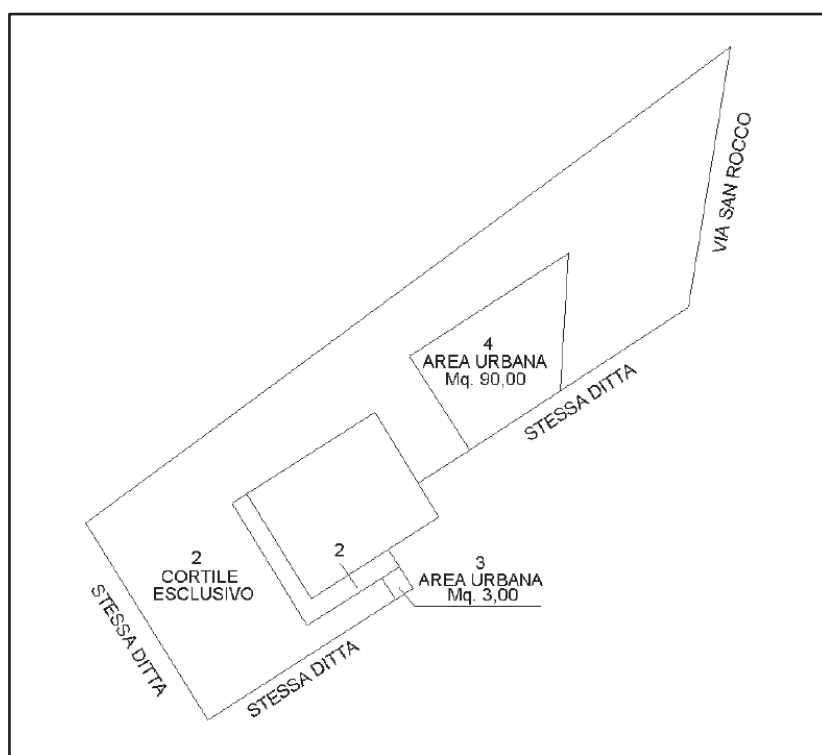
Estratto dell'elaborato planimetrico del mappale 153 (piano terra)
